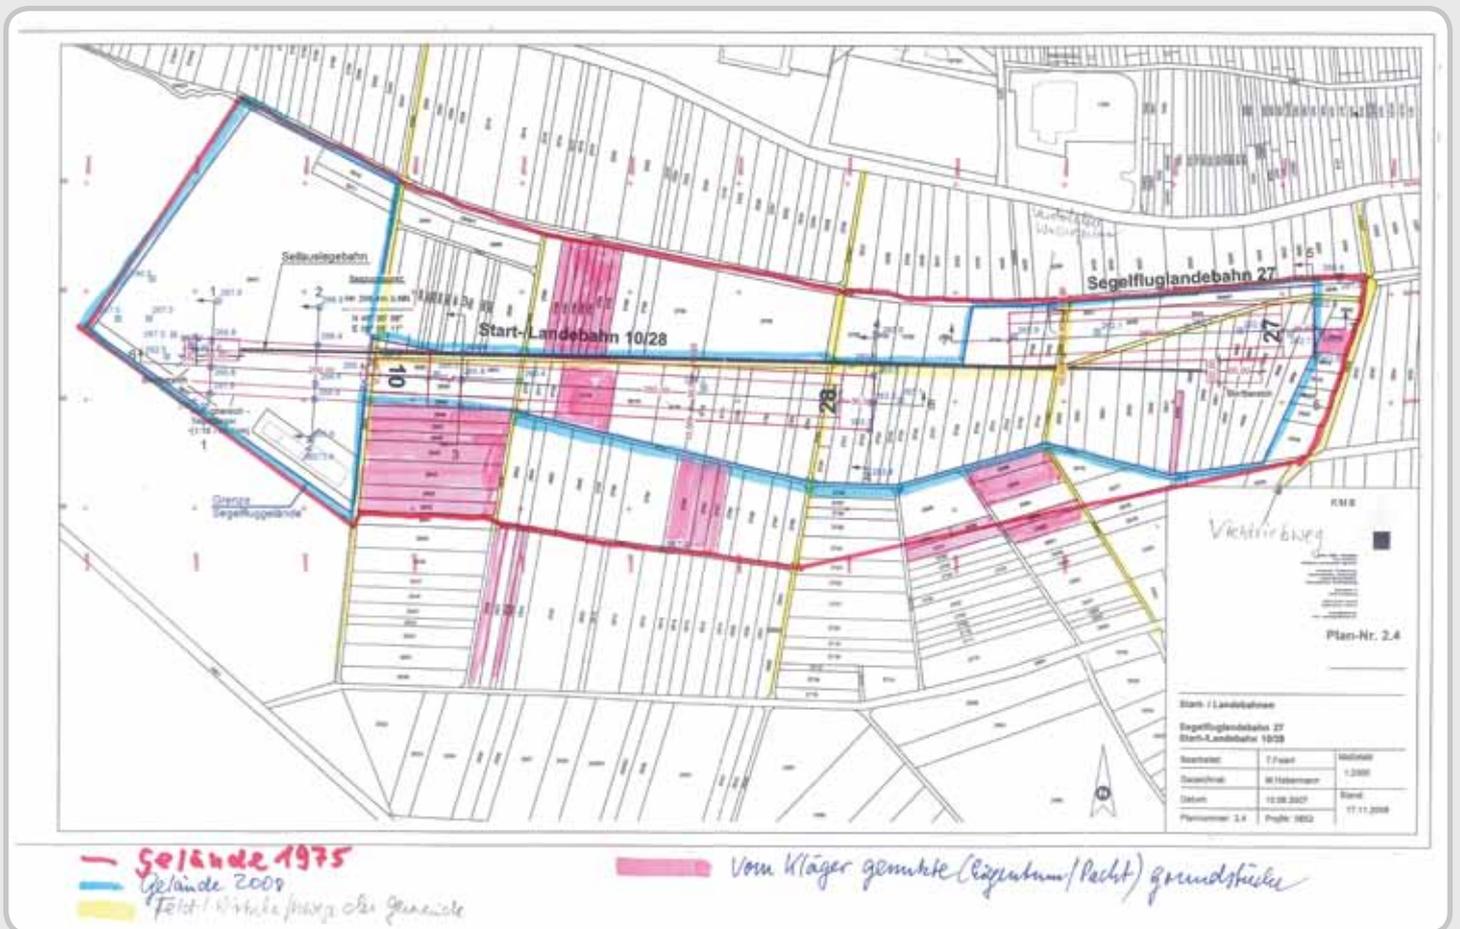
Lageplan mit Geländemaßen 1975 (rot) und 2008 (blau)
